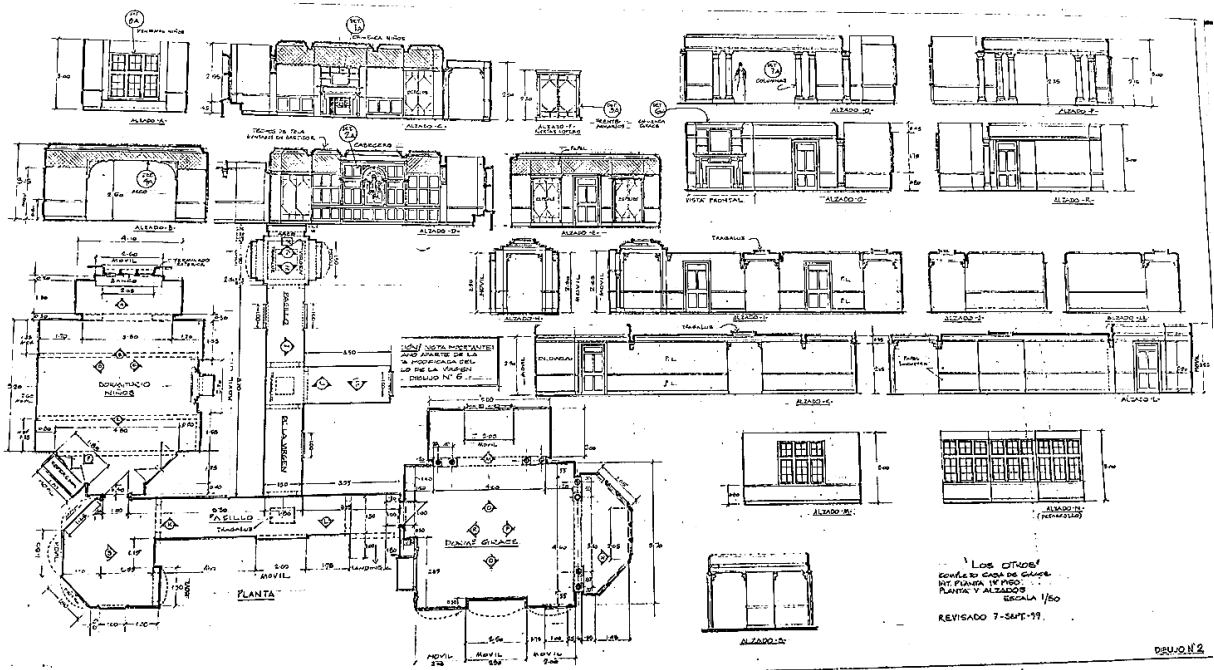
Planos. Planta y alzados del complejo casa de Grace. Interior piso 1°. Los otros Fuente: Benjamín Fernández.
